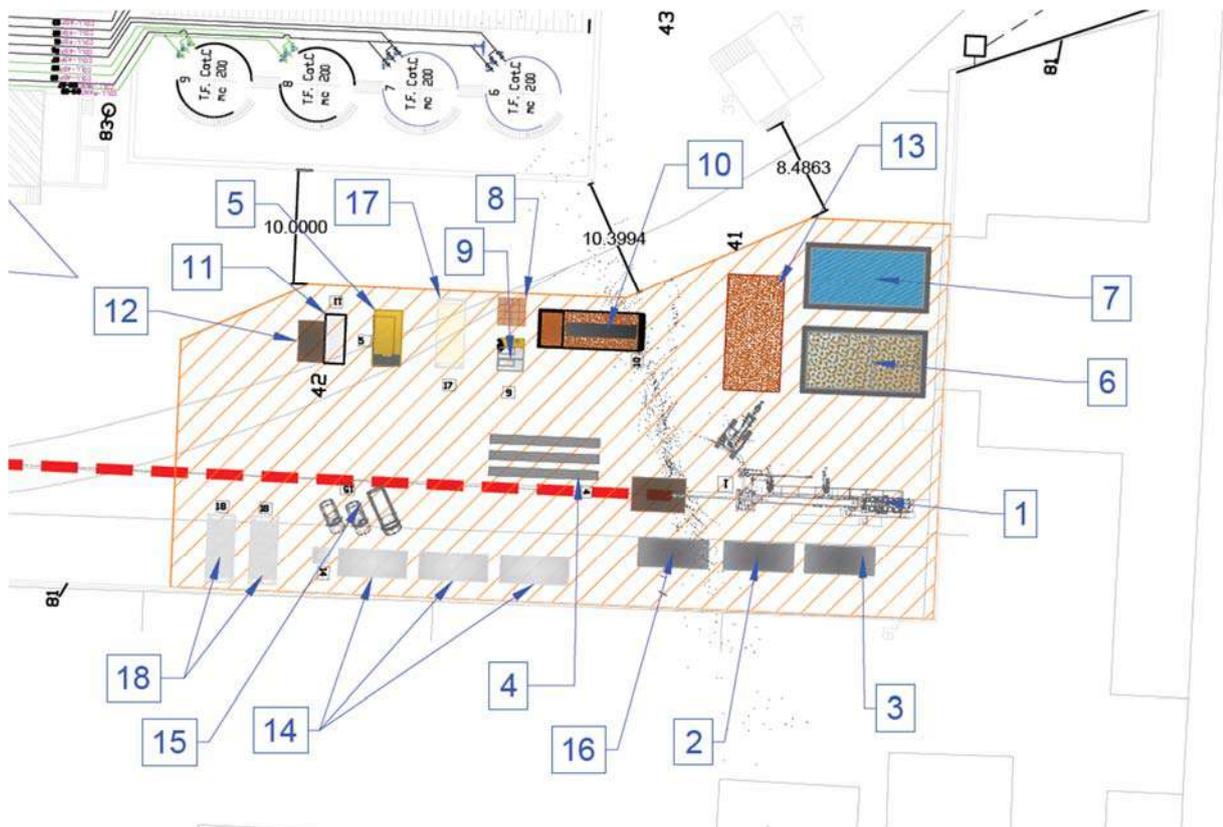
Cantiere lato Est – sistemazione delle aree – stabilimento di via Righi
